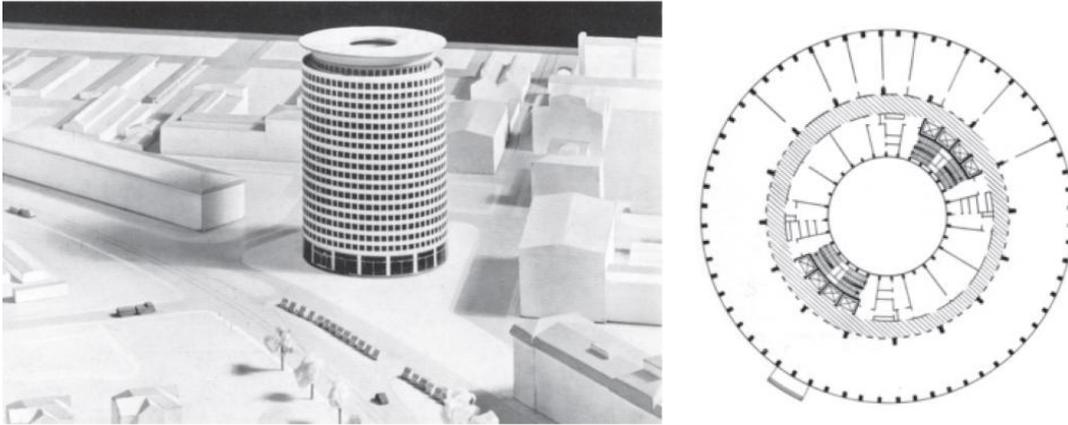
Modell und Grundriss für das BASF-Gebäude von Erich Meyer
